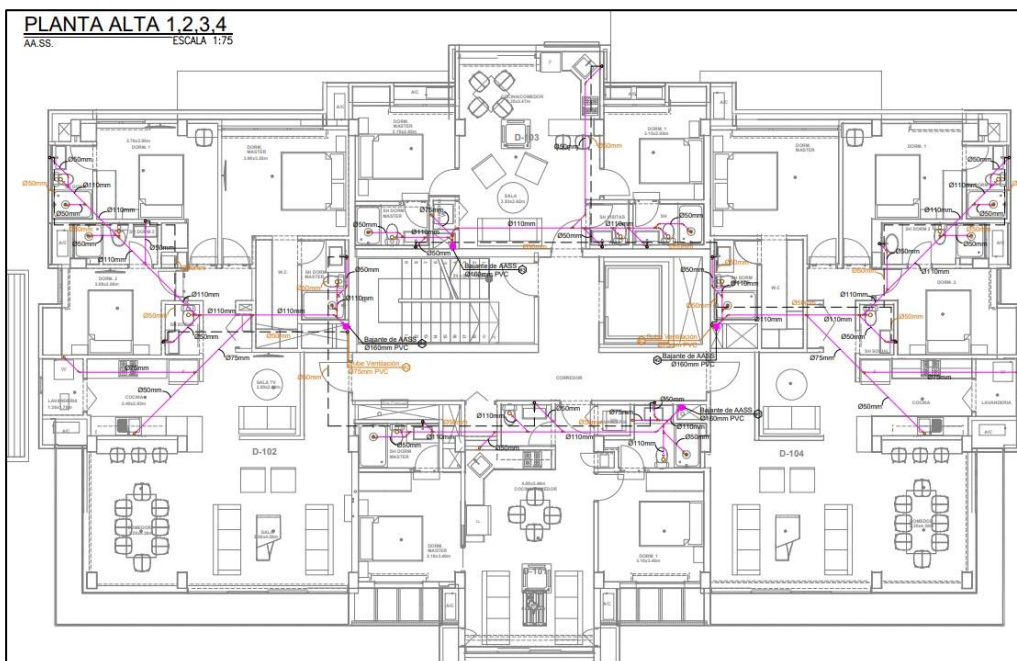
Plano de AASS de Planta Alta 1,2,3,4
